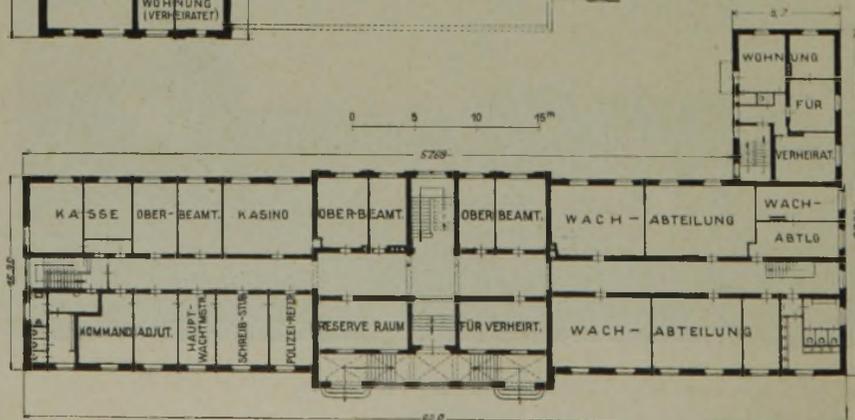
Erdgeschoßgrundriß (1 : 600)
